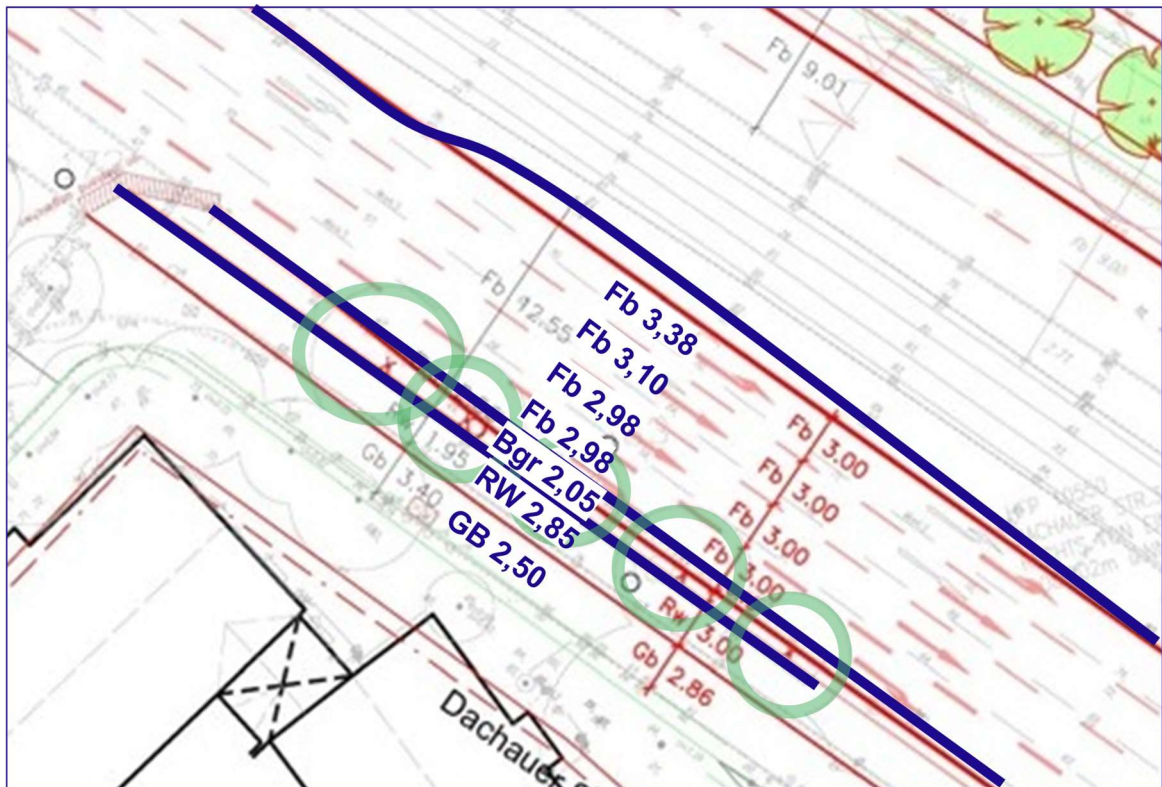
Darstellung Straßenraum Planung (Rot) und Bestand mit RSV (Blau)
